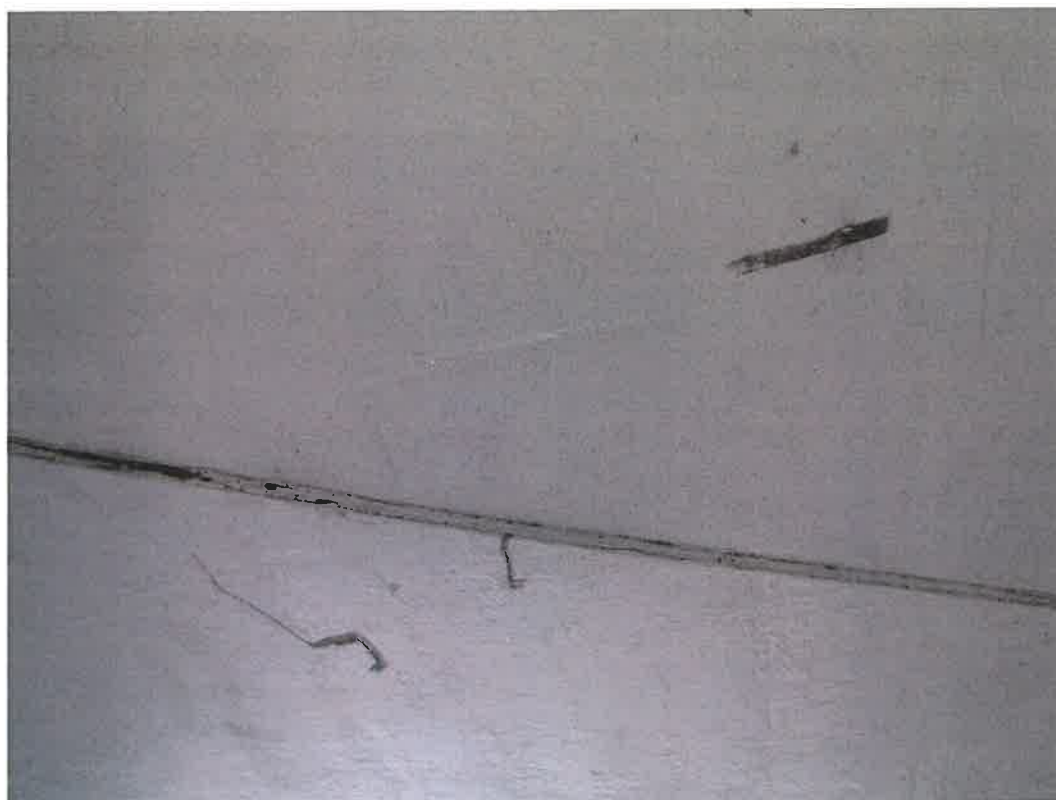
złuszczenie powłoki ochronnej do betonu na czole przęseł
